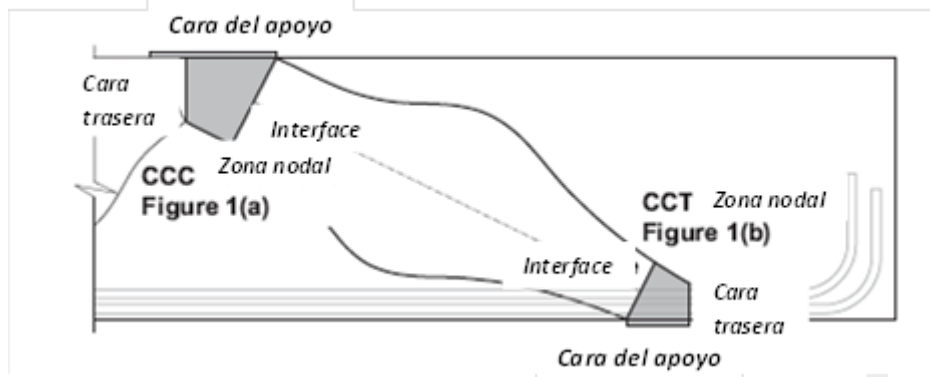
Modelo Puntal – Tirante para una viga profunda (alta)
